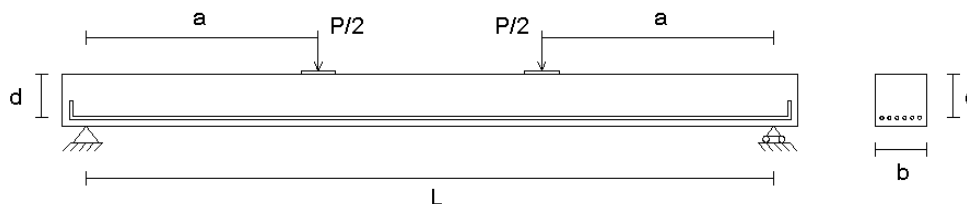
Ensayos Chang y Kesler. Geometría de las vigas ensayadas.
